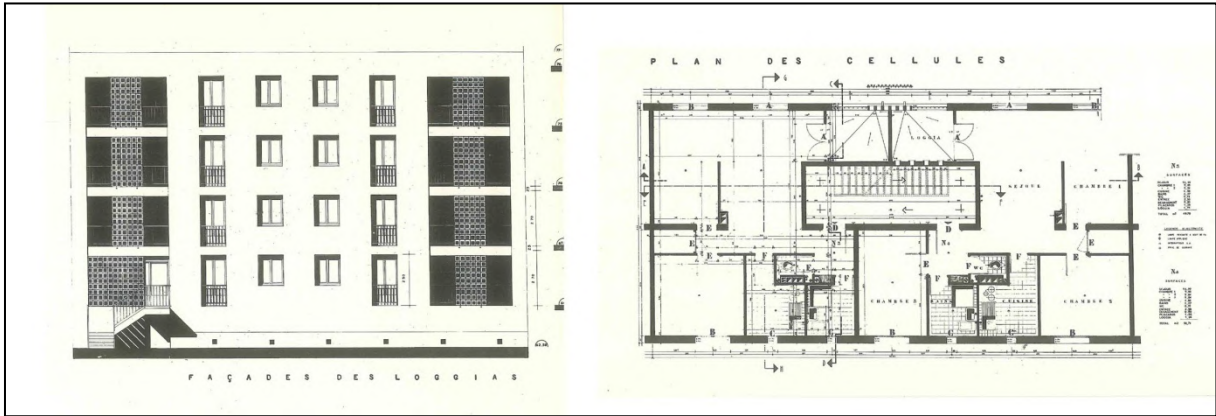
Cité Les Apôtres. Façade et plan des cellules. In. Recueil des travaux de l'agence Daure et Béri.
